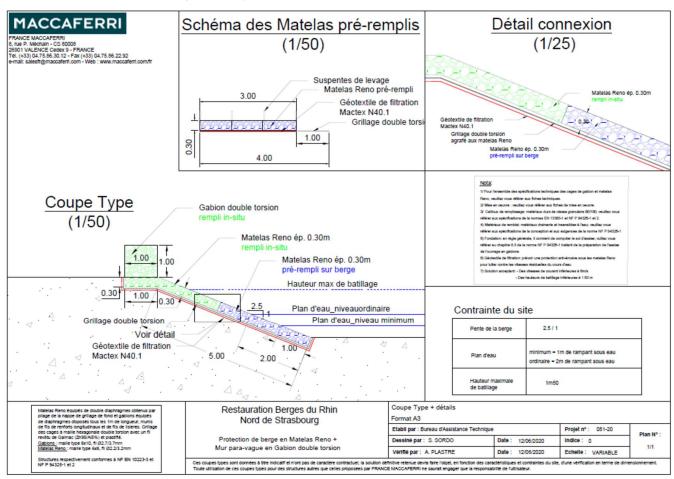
Coupe type de la protection (source : DLE, VNF 2021)
